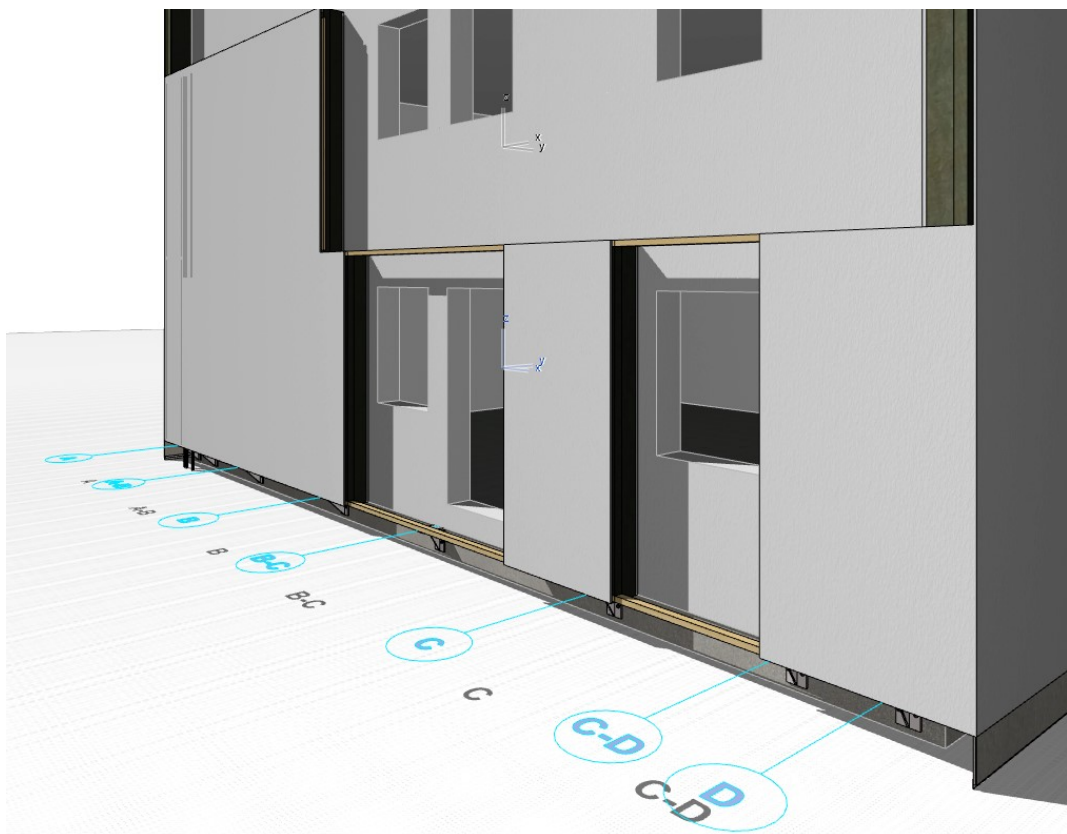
/ Montage der Grundelemente inkl. Schichten
